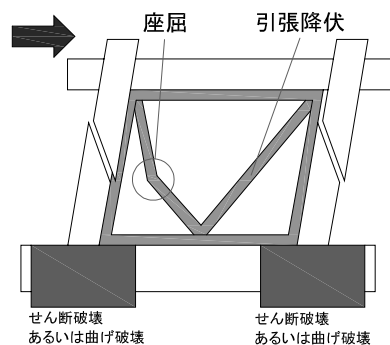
10通りの軸組と梁のひび割れ状況
